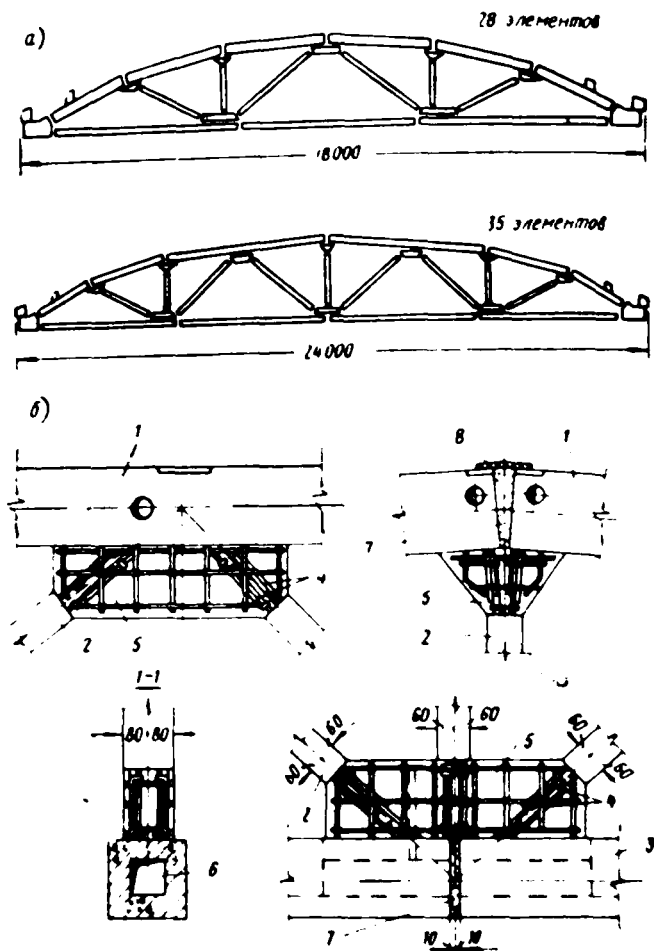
Фермы из линейных элементов с пучковой арматурой
